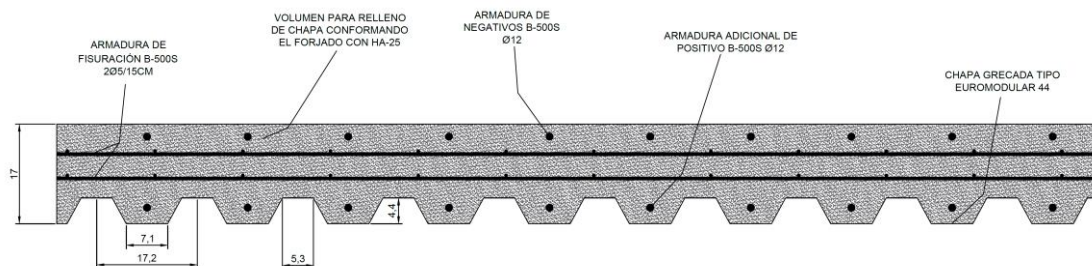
Sección transversal de la alternativa 4 (Fuente: elaboración propia)
